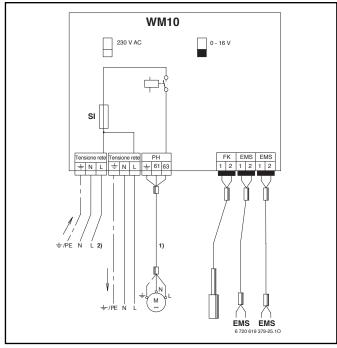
Schema elettrico del modulo di compensazione idraulica WM10
